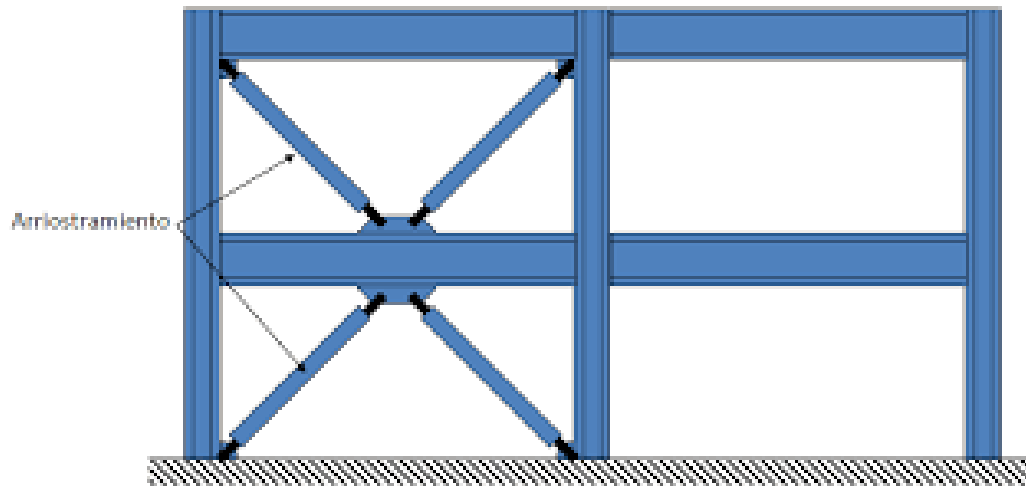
Sistema Estructural: Pórtico de acero laminado con diagonales
